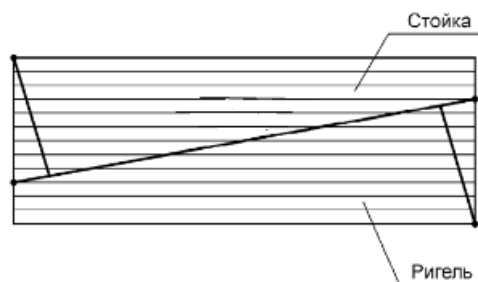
Клееная заготовка для изготовления стойки и ригеля рамы
